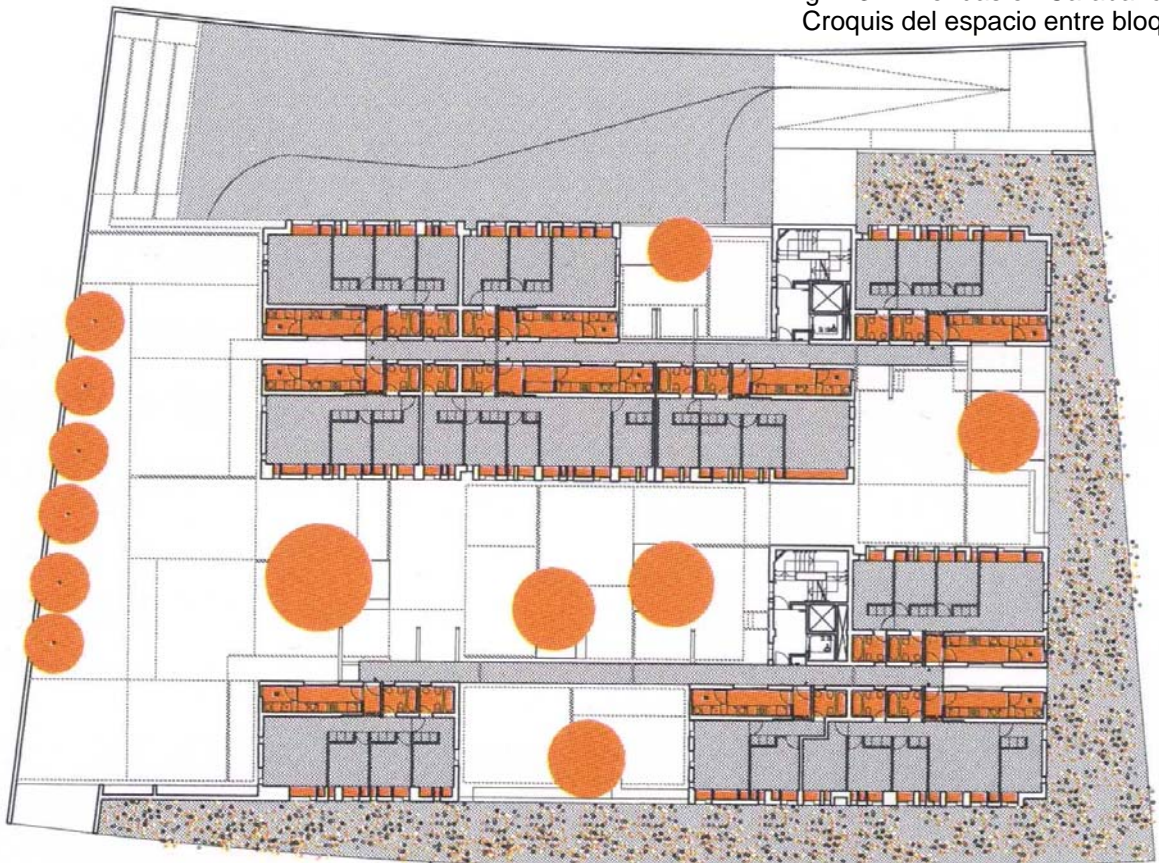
Sergio de Miguel y Cristina López. 60VPP en Carabanchel. Planta tipo
